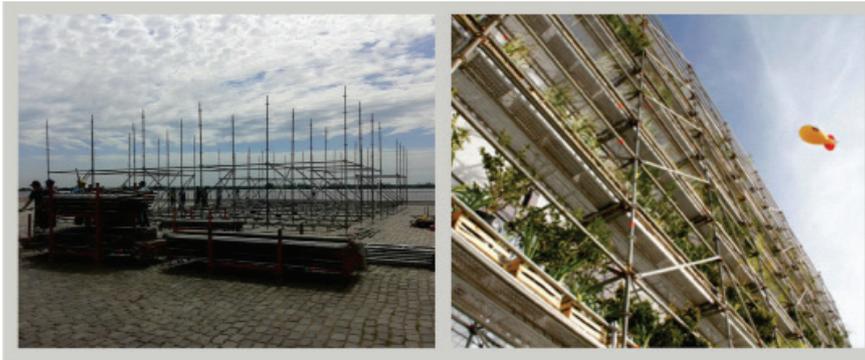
El Pabellón de la IX BIAU construido (2014)
